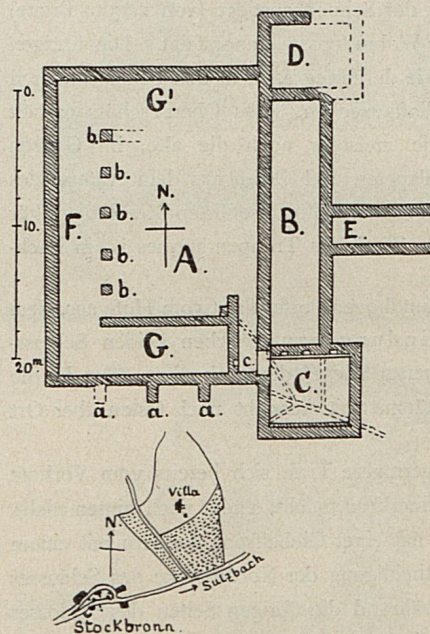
Grundriss eines römischen Landhauses bei Stockbrunn.
